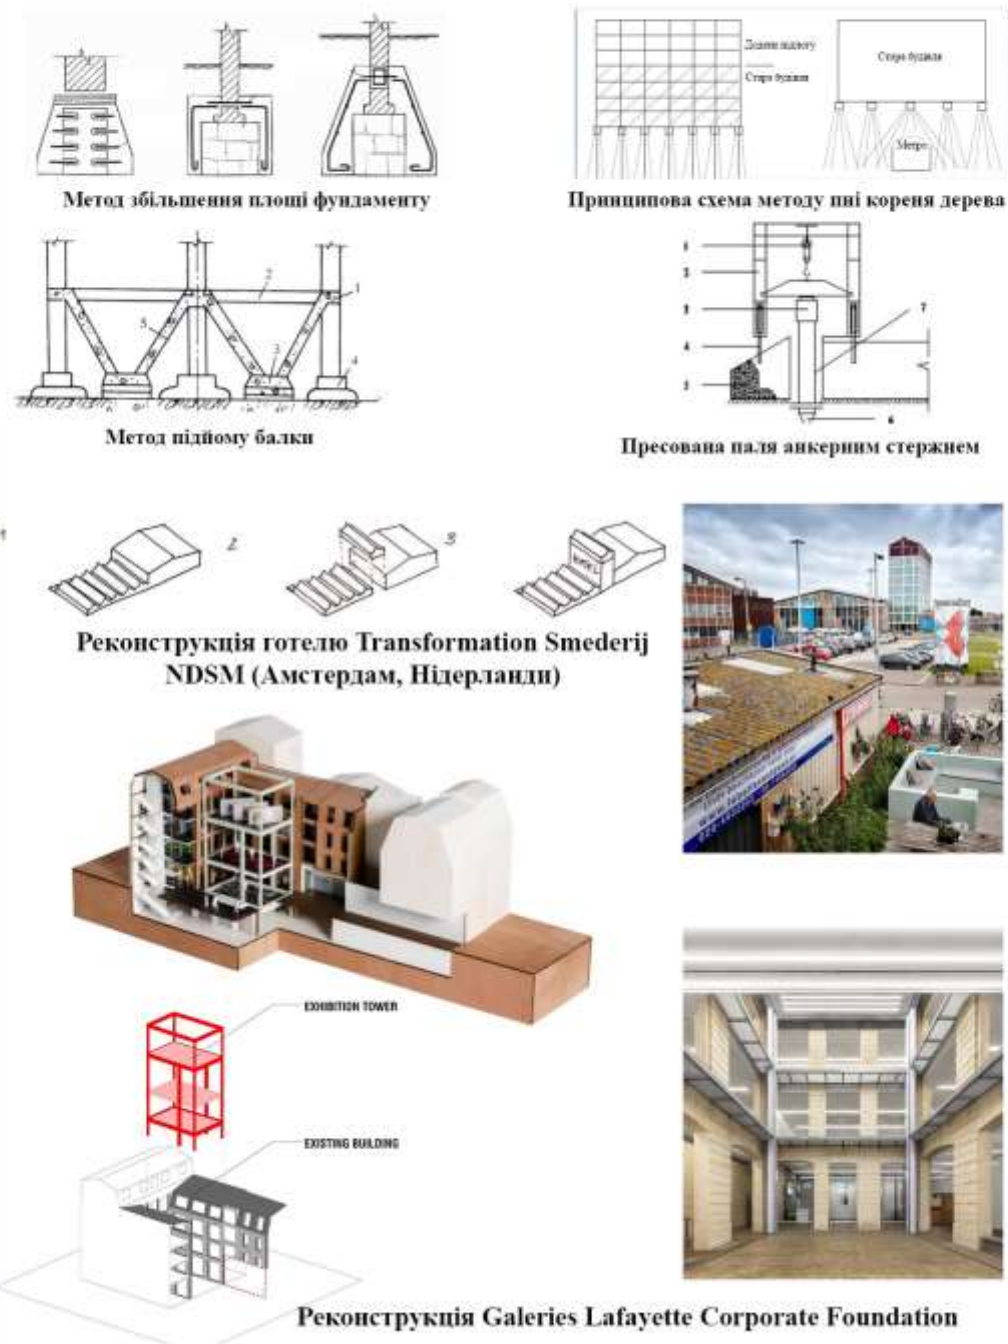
Посилення фундаментів промислових будівель при реконструкції
